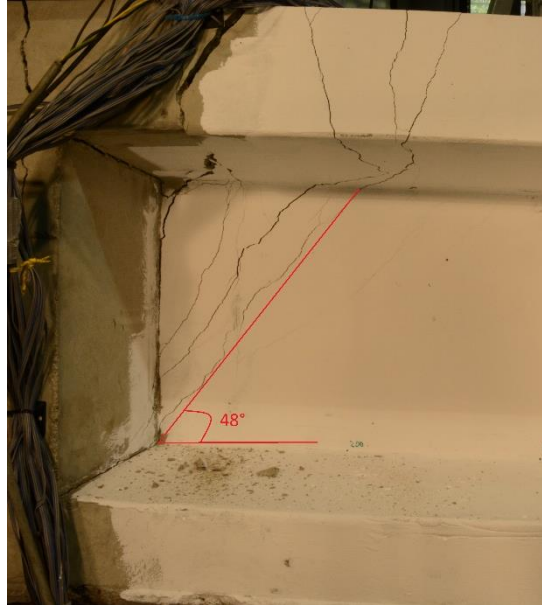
Ángulo de fisuración en la viga 1
